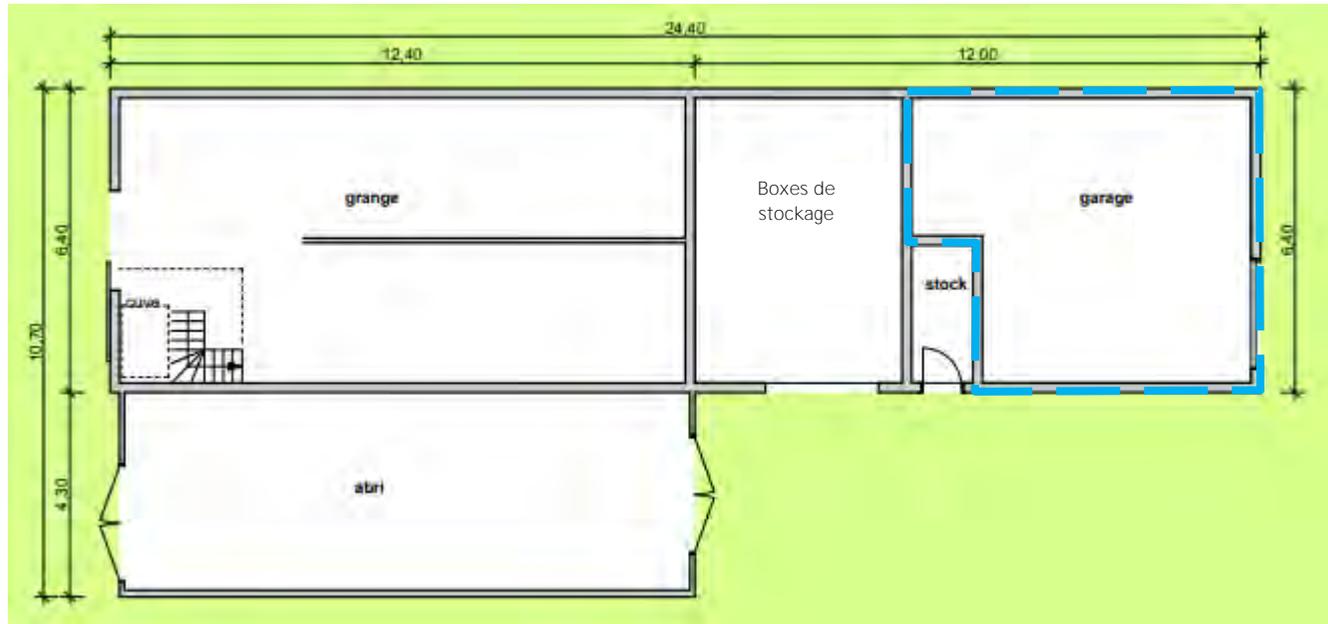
Plan des bâtiments, en bleu : garage recensant du guano (Source : Atelier-S Sébastien Nuttens Architecte DPLG)
